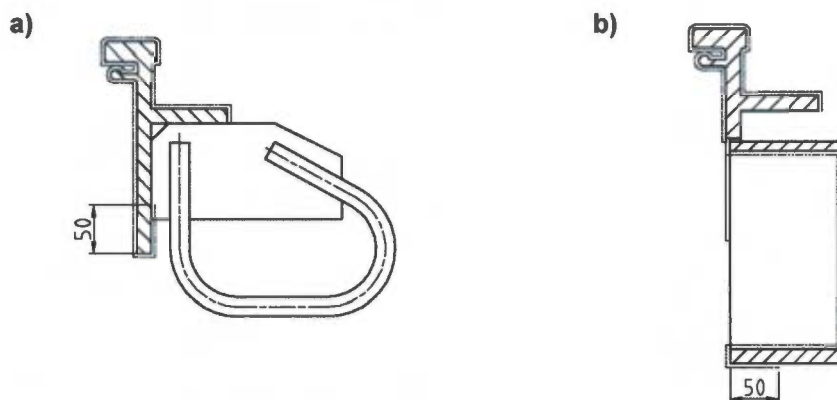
Beschichtung der betonberührenden Bauteile: a) Randprofil, b) Traversenkasten
